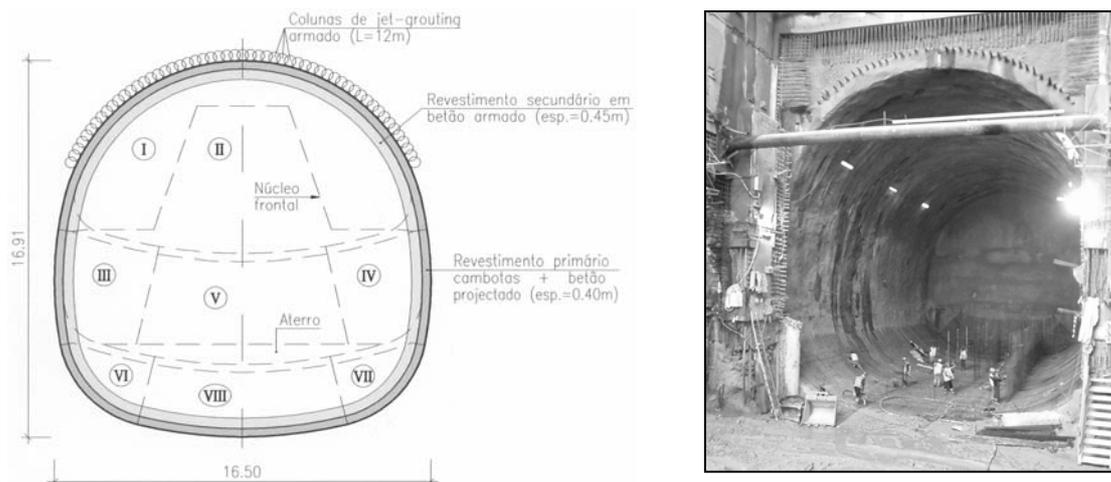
Secção transversal tipo, faseamento executivo e vista do Túnel 1 na fase final de instalação do revestimento primário
